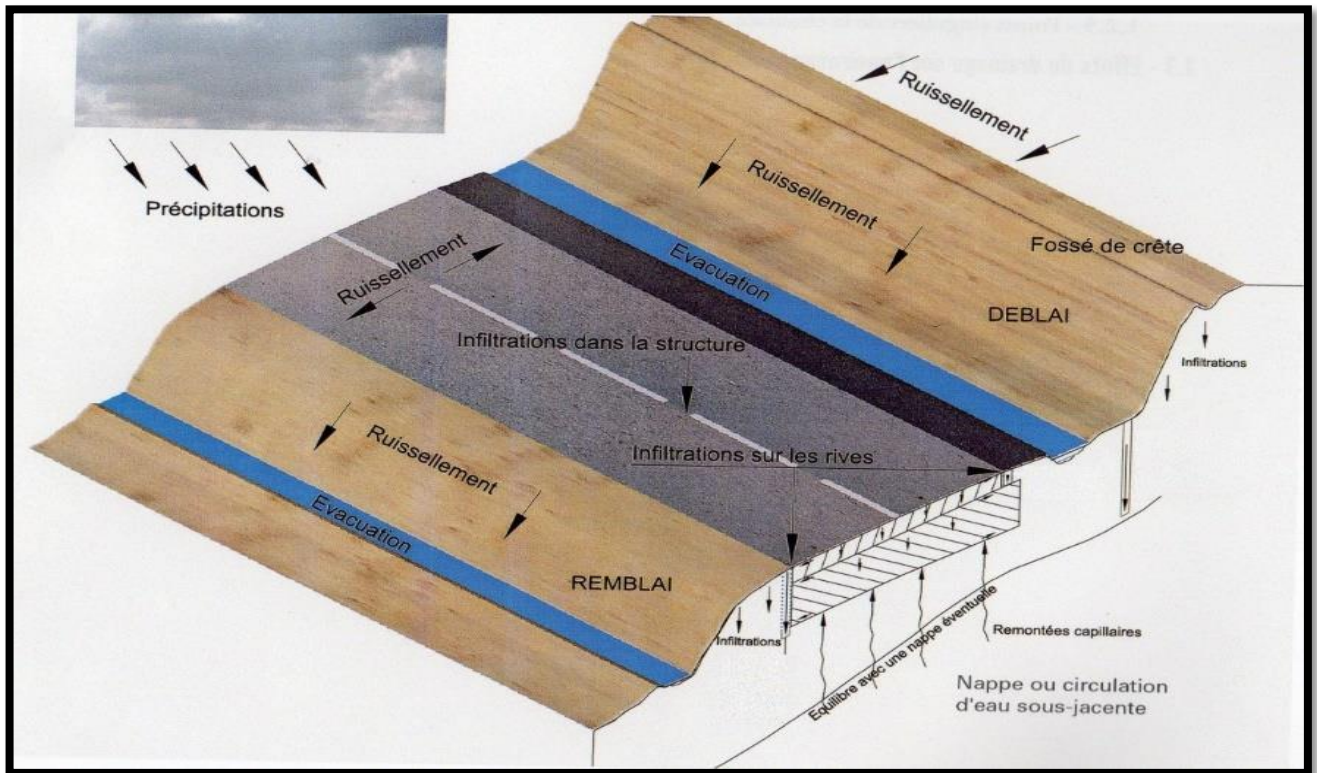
l'emplacement des ouvrages d'assainissement.
